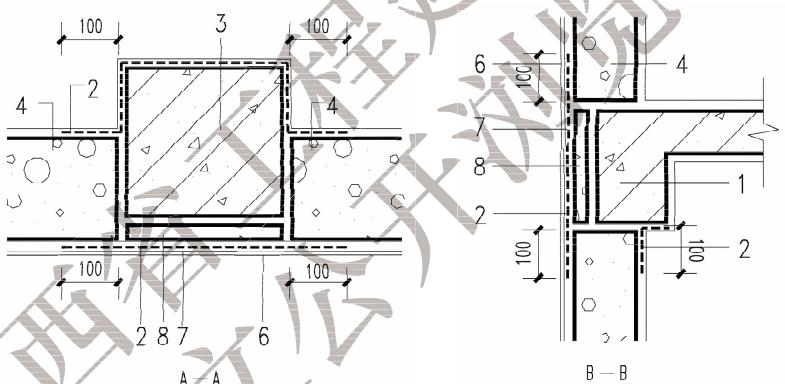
自保温砌块墙体与钢筋混凝土梁、柱、墙交接面抗裂加强处理示意
